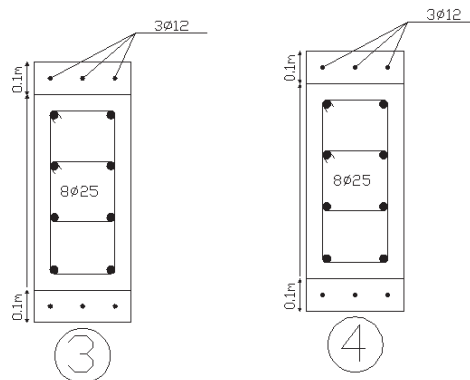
Secção transversal dos pilares do r/r do PT8 após reforço através da técnica de encamisamento de pilares - direcção transversal.
